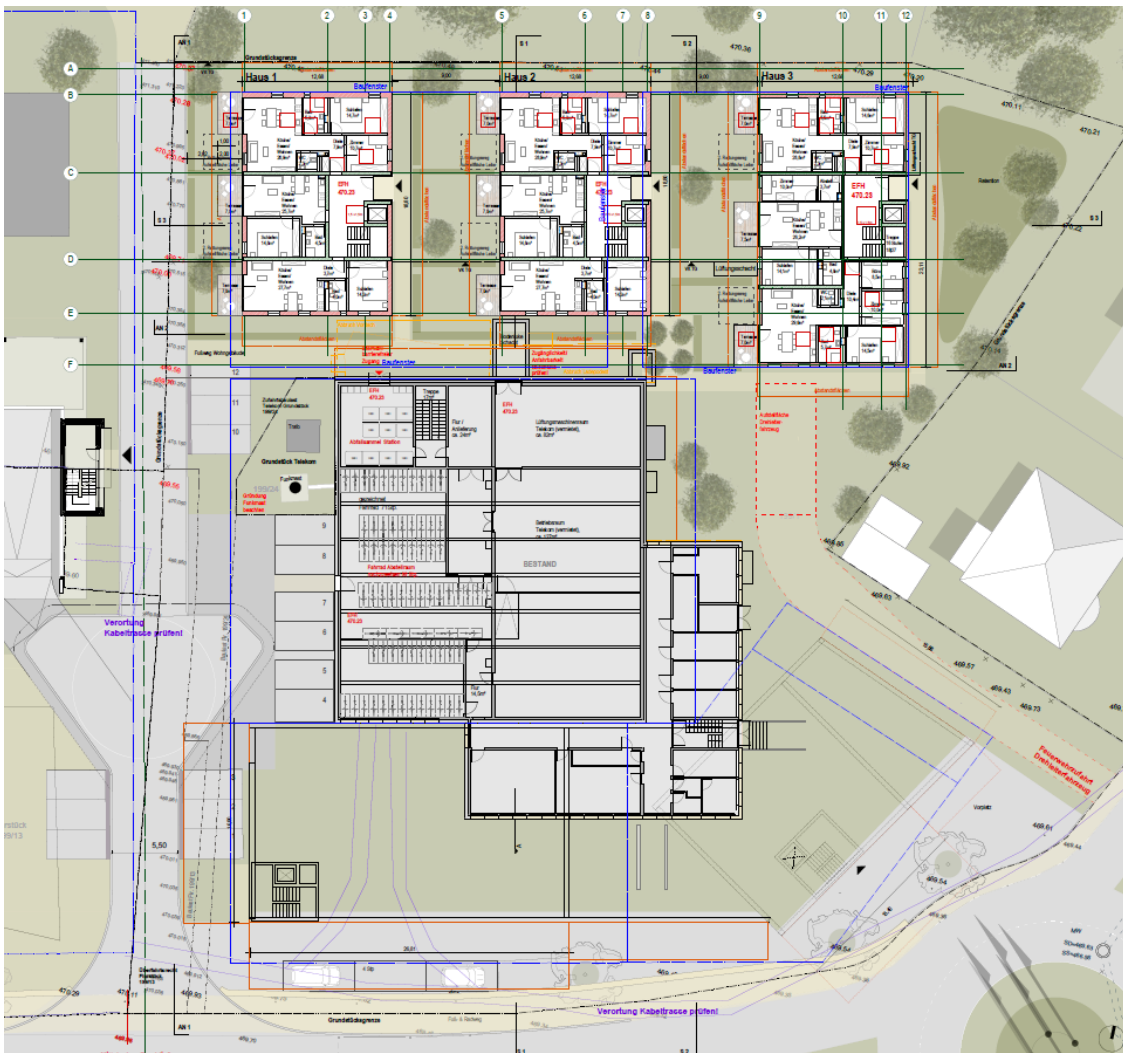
Telekomareal, 3 Stadtvillen – Grundriss Erdgeschoss (Grath Architekten BDA, Stand 12/2021)
